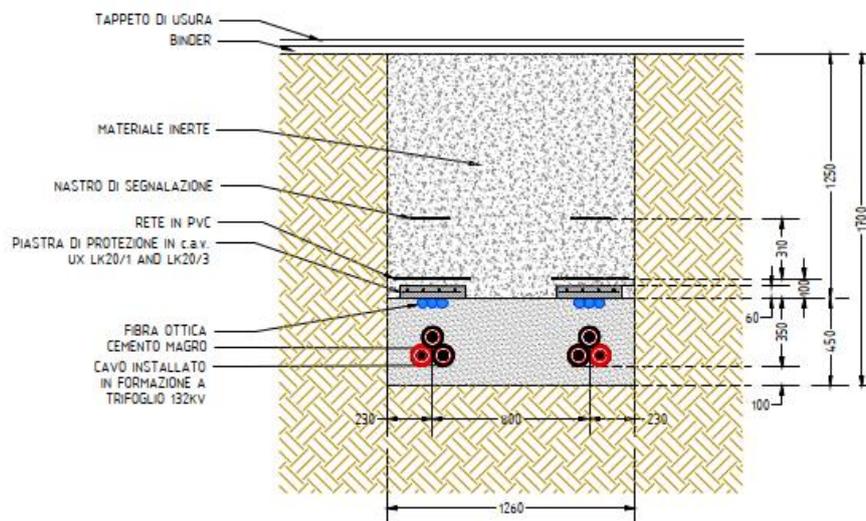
Sezione tipo stradale – Tratto di cavidotto dal punto di giunzione alla SE di Trasformazione.
